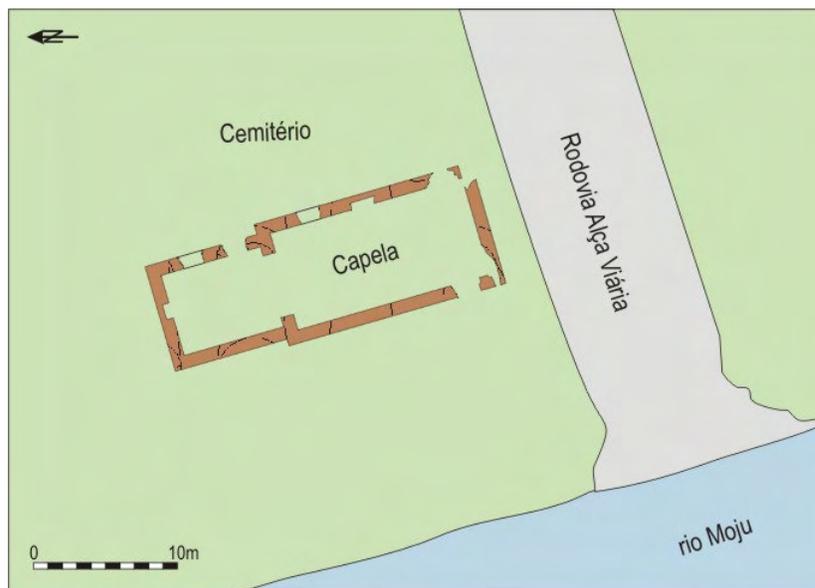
Planta da Capela localizada na área do Engenho Jaguarari, cuja área frontal foi inteiramente destruída pela implantação de alojamento e canteiro de obras para a construção uma ponte sobre o rio Moju, parte do projeto da rodovia Alça Viária.
